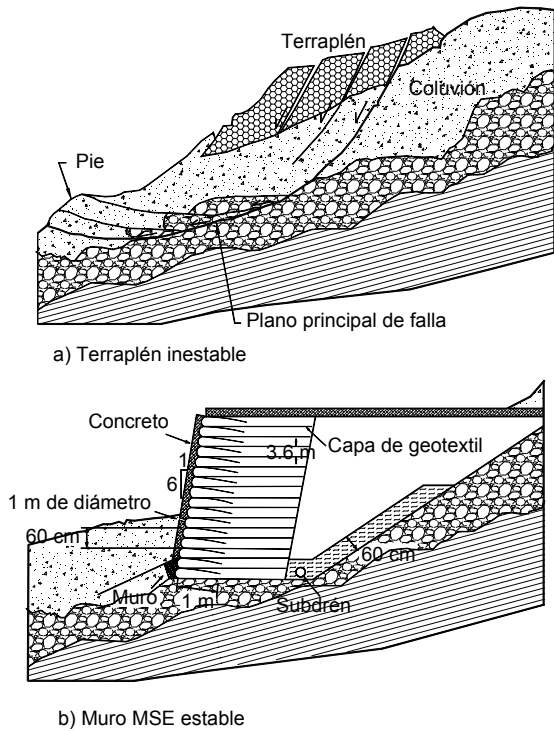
Esquema de estabilización utilizando muro MSE.
